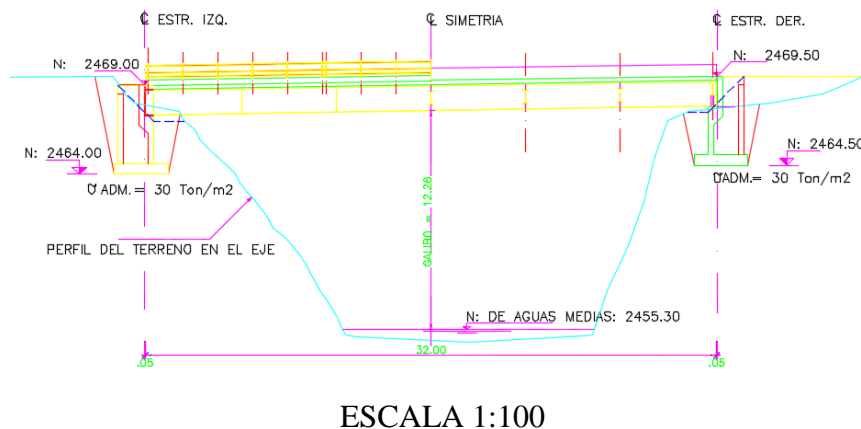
Vista en elevación del puente de hormigón armado La Concordia.
